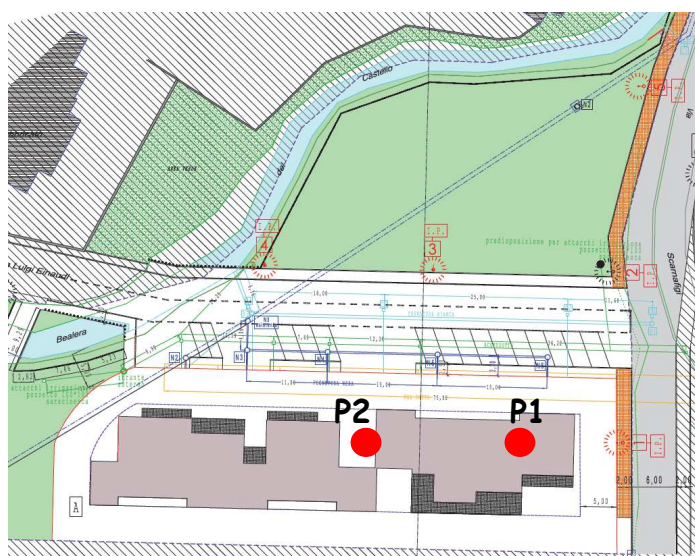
Planimetria di progetto con ubicazione pozzetti geognostici (non in scala)
